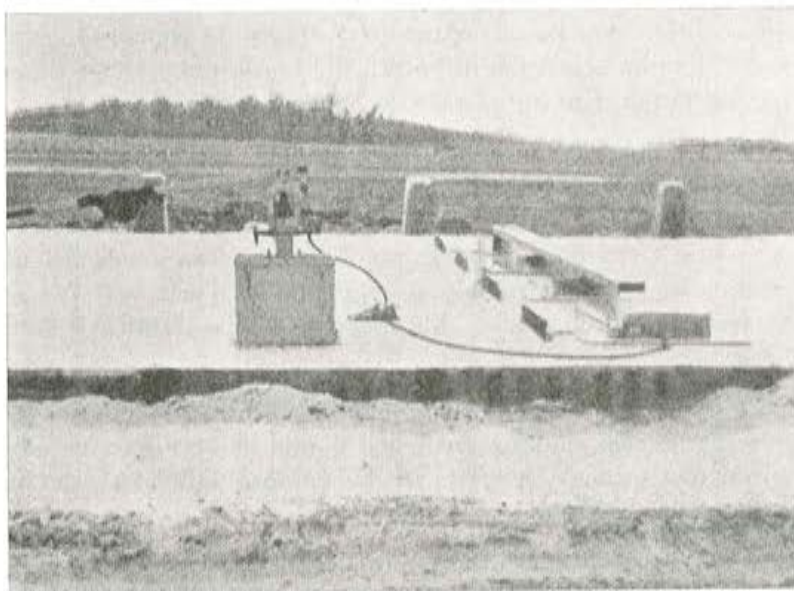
Vista de la junta activa durante el pretensado del pavimento.
